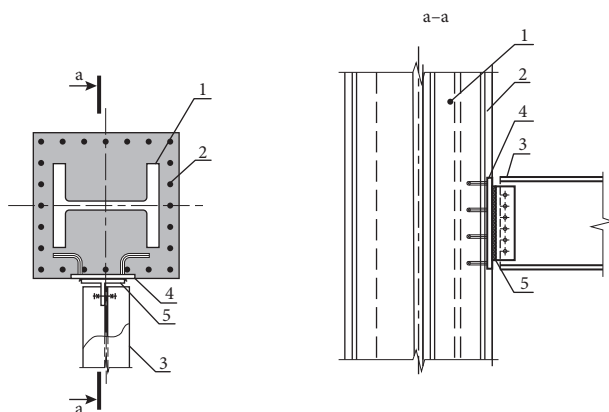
Узел опирания стальной балки к бетонной части сталежелезобетонной колонны через закладную деталь. 1 — жесткая арматура, 2 — гибкая арматура, 3 — стальная балка, 4 — закладная деталь, 5 — флажок
